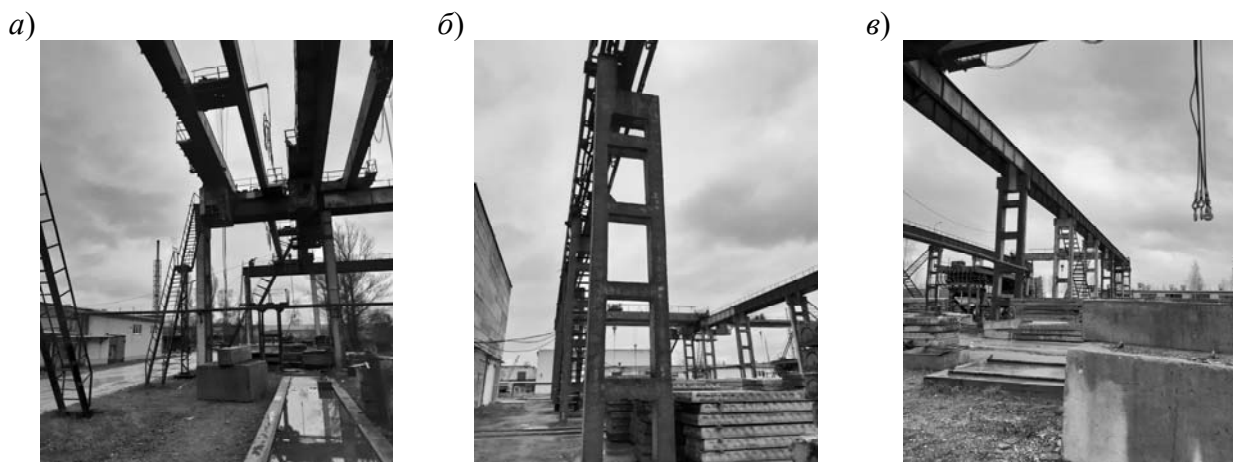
Вид на обследуемый пролет открытого склада № 4: *а* – вид на мостовые электрические краны; *б* – вид на двухветвевые железобетонные колонны; *в* – вид на стальные балки
